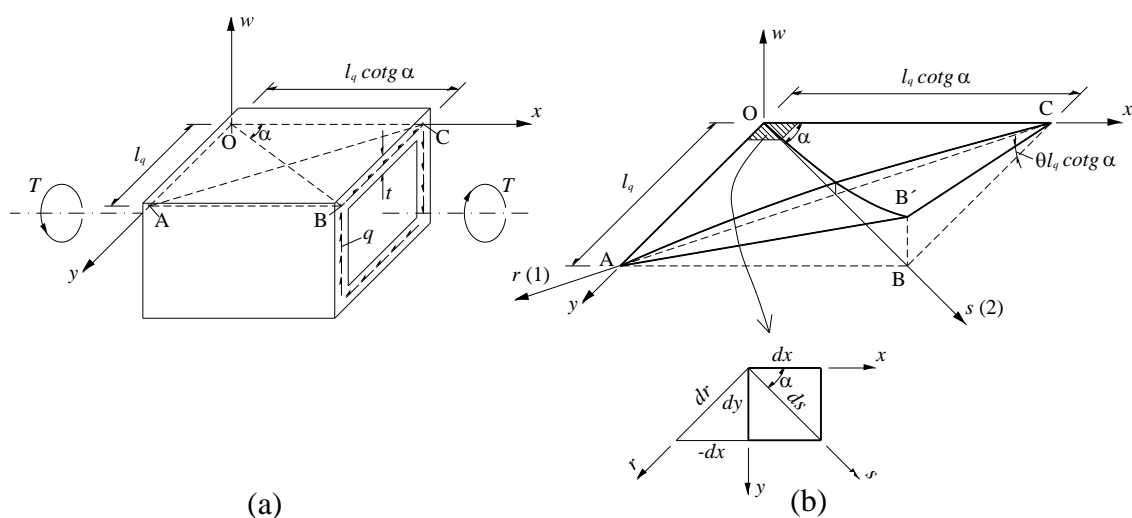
Flexão de uma escora e de um tirante de betão na parede de uma viga caixão [23]
